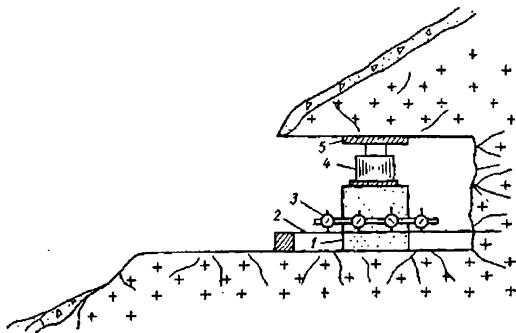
Схема установки для испытания горных пород в подземной горной выработке пробными статическими нагрузками:
